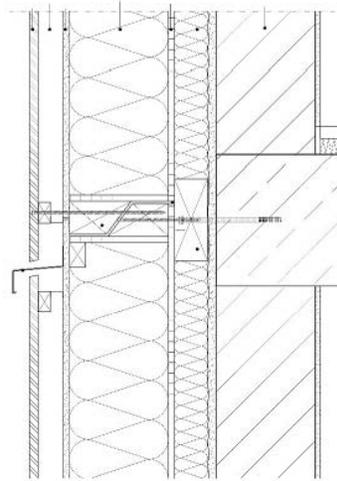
Fissaggio degli elementi nella trave di ancoraggio
